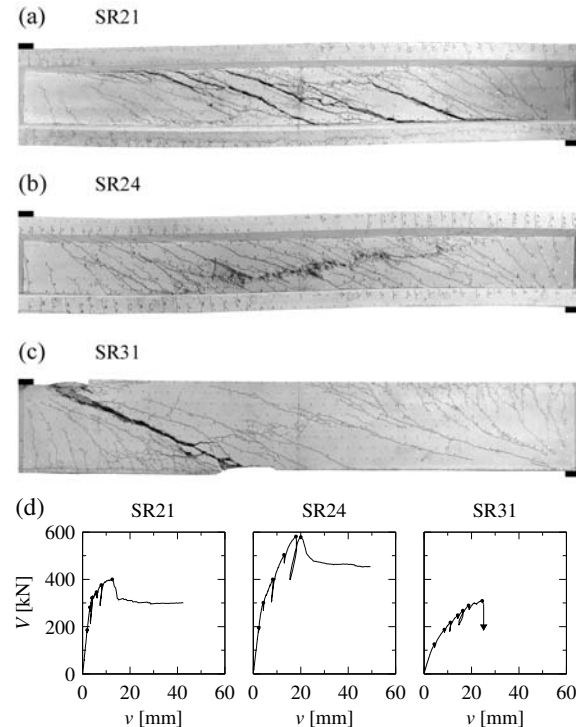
Rissbild und Abplatzen der Betonüberdeckung im Versuchsbereich ($x = 2600 \div 7400$ mm) nach Versuchsende dreier Träger: (a) SR21 – Rissbildung über größeren Bereich mit grossen Rissöffnungen und Ablösen der Flanschen; (b) SR24 – Versagen der Betondruckdiagonalen im Bereich des Vorspanngliedes; (c) SR31 – Verformungslokalisierung in einem Riss; und (d) Querkraft (V) gegen Durchbiegung (v) an der Krafteinleitstelle im Feld ($x = 2600$ mm) mit Angabe der Laststufen.
